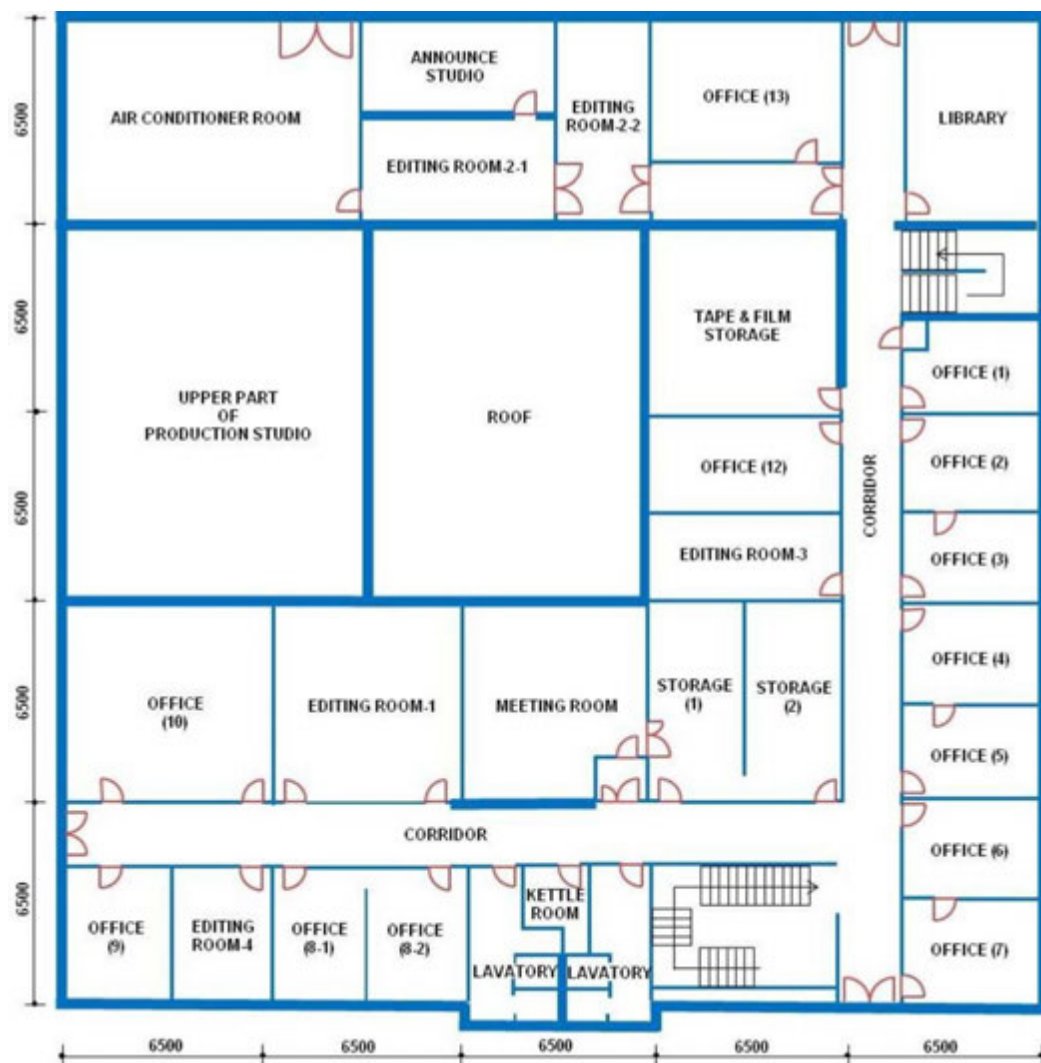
カブル・テレビ放送局 2 階平面図
